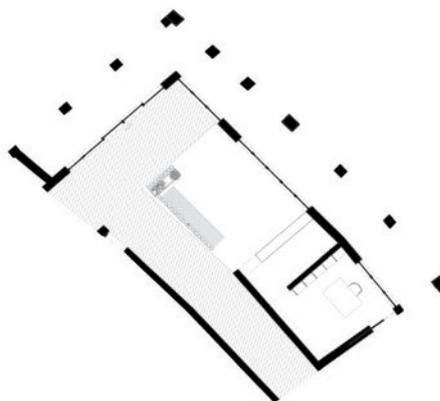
Planta Piso 0 | Localização da Recepção | Volume B
